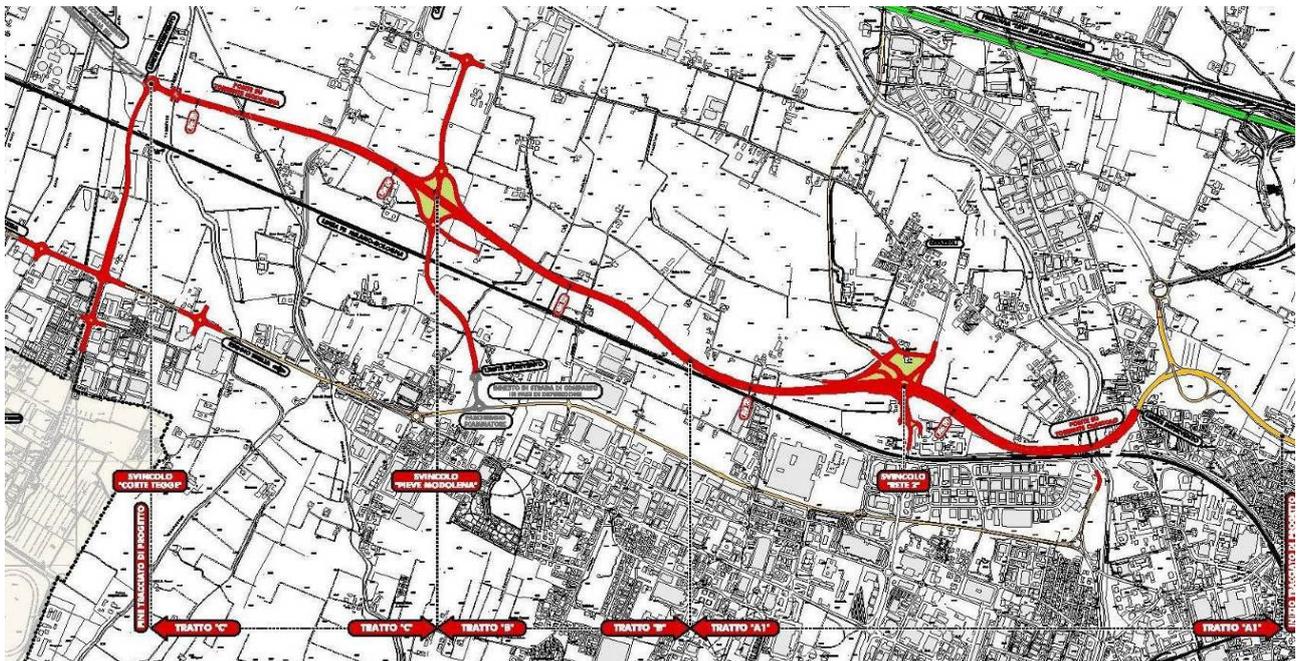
Tracciato nella configurazione di progetto prescelta
